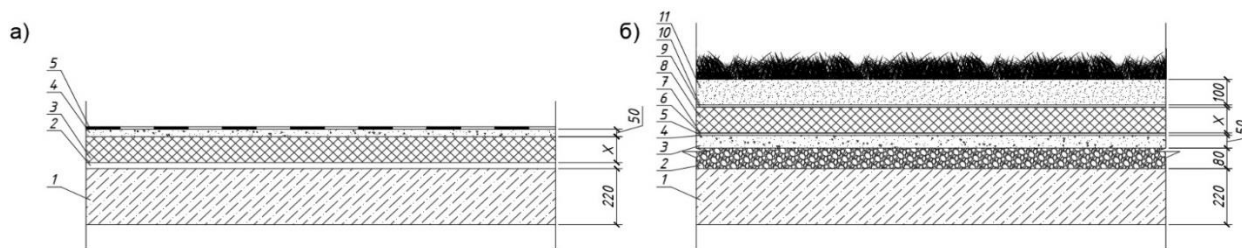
а) конструкция «традиционной» крыши: 1 – железобетонная плита, 2 – пароизоляция, 3 – плиты на основе минеральной ваты, 4 – цементно-песчаная стяжка, 5 – гидроизоляционный слой; б)
